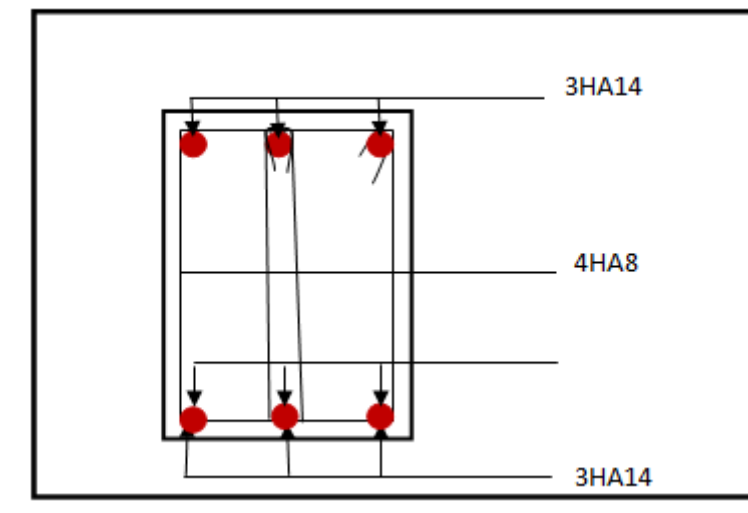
Ferrailage aux appuis d'une poutre secondaire.
